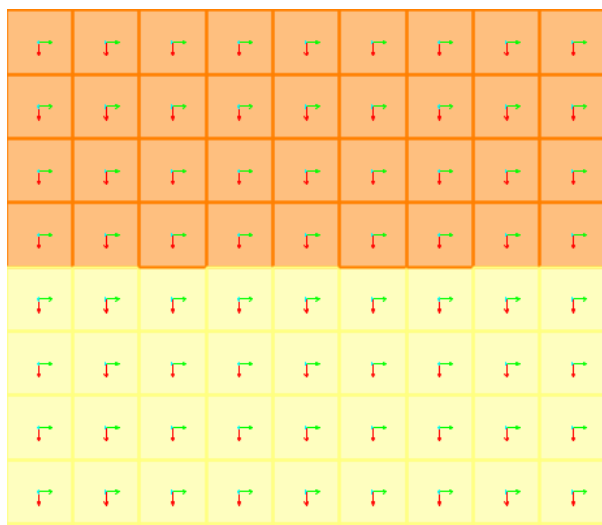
EIXOS LOCAIS DA LAJE - EIXOS E6 A E8
